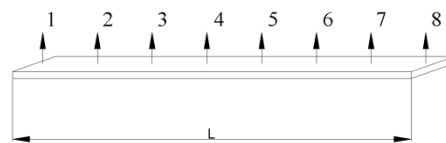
Distribución de los acelerómetros en las vigas de vidrio laminado
